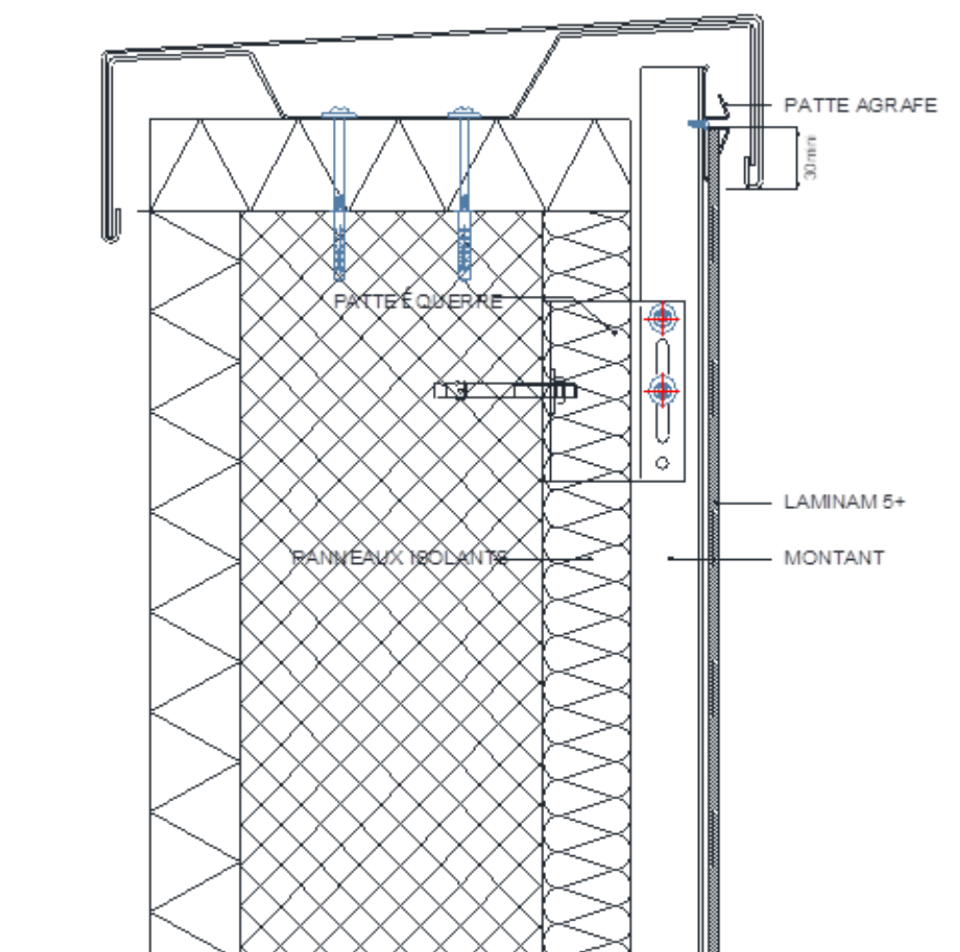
Exemple des profils en L - Pose horizontale - Profilé pour fixation avec vis
